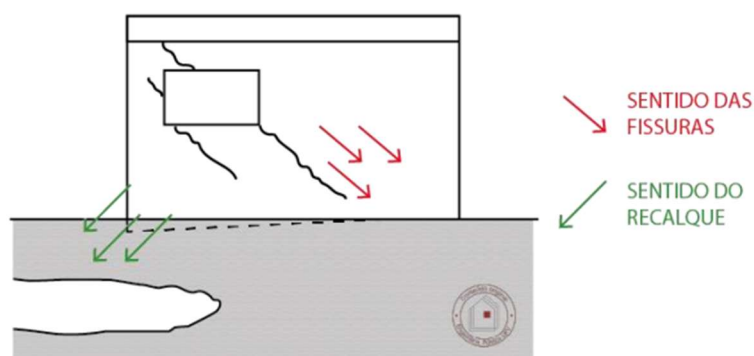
Fissura diagonal devido ao efeito do cisalhamento e tração pelo deslocamento do elemento estrutural em balanço.
